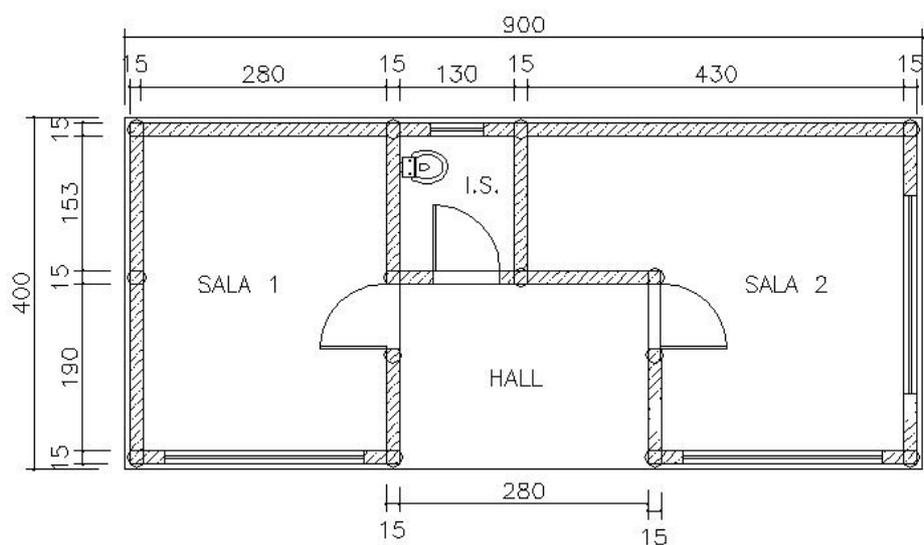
Planta baixa da sede da Escola (sem escala).
